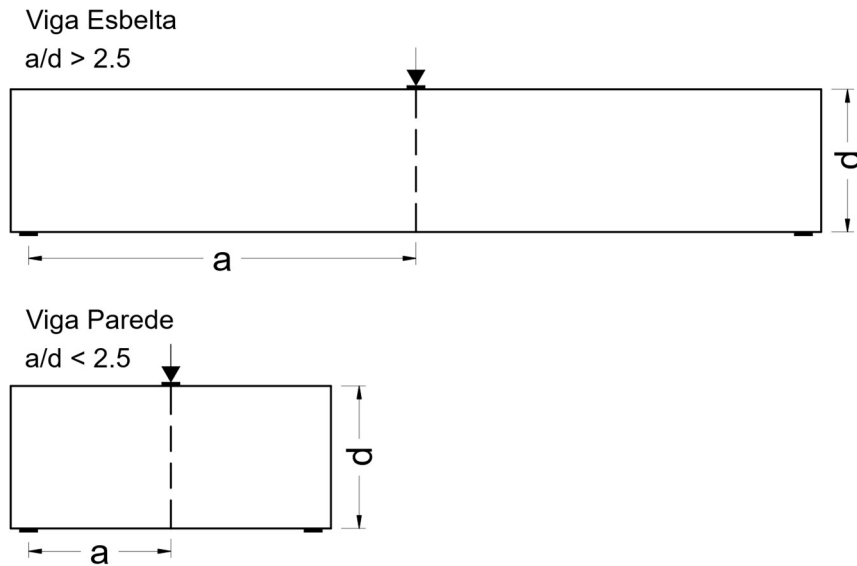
EXEMPLO DE VIGA PAREDE
